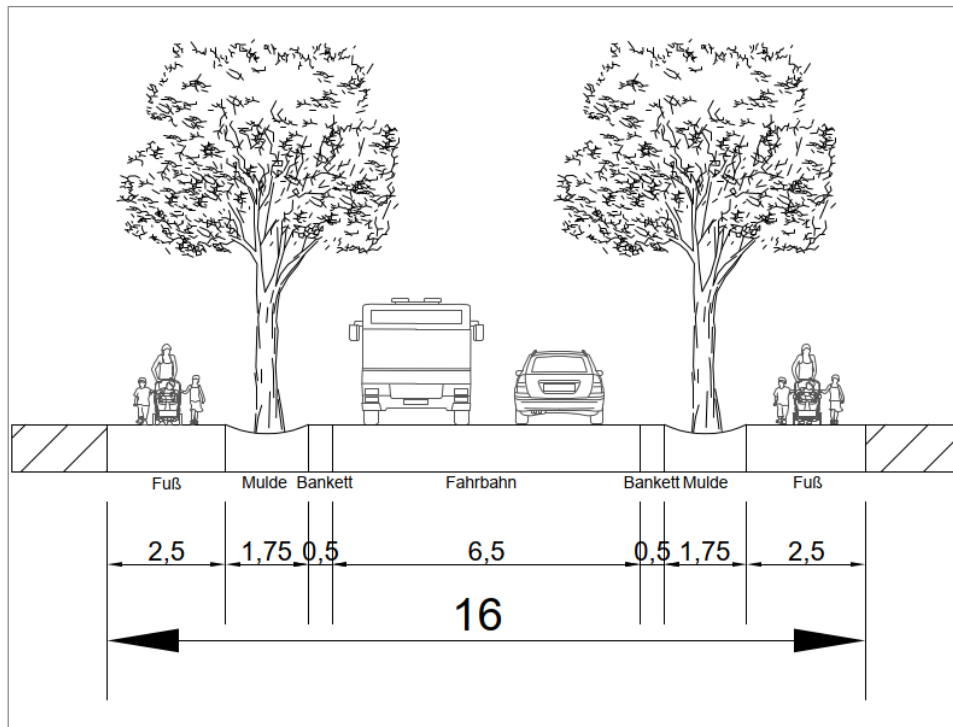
Straßenquerschnitt 16m (Planstraße 1)
